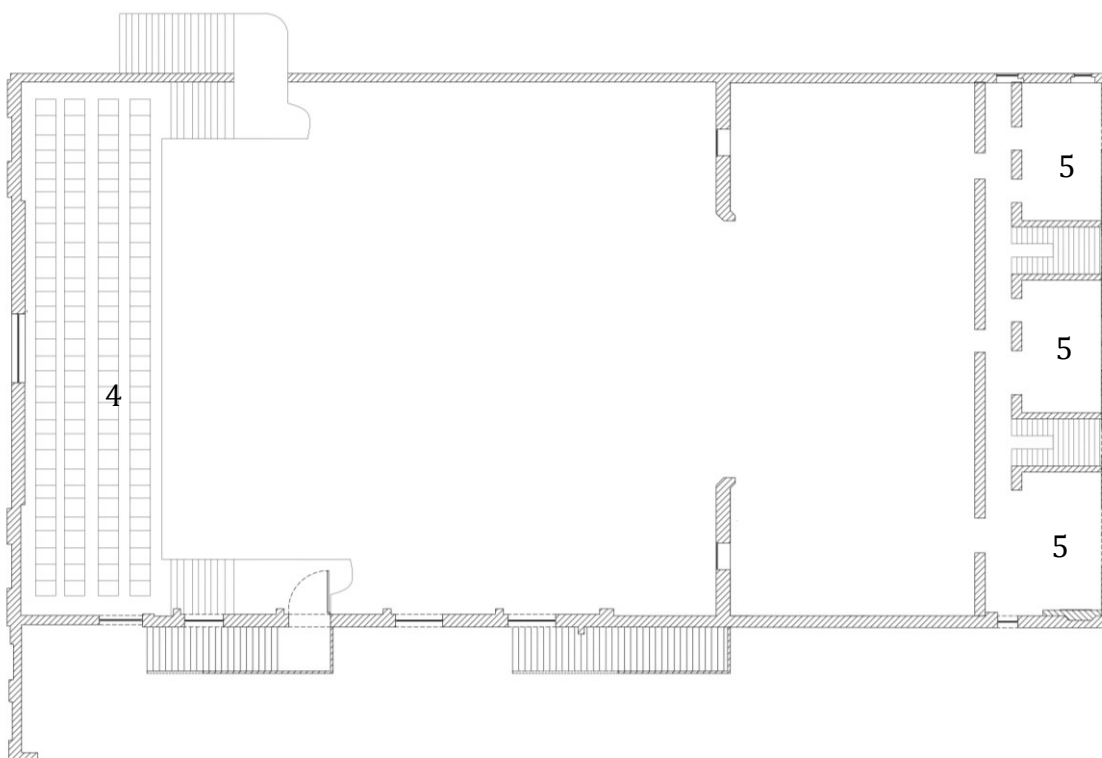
Planta original, Piso 3, Fonte: Autor
